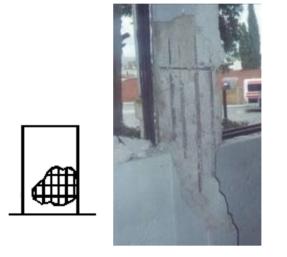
Desprendimiento del concreto y acero de refuerzo expuesto
